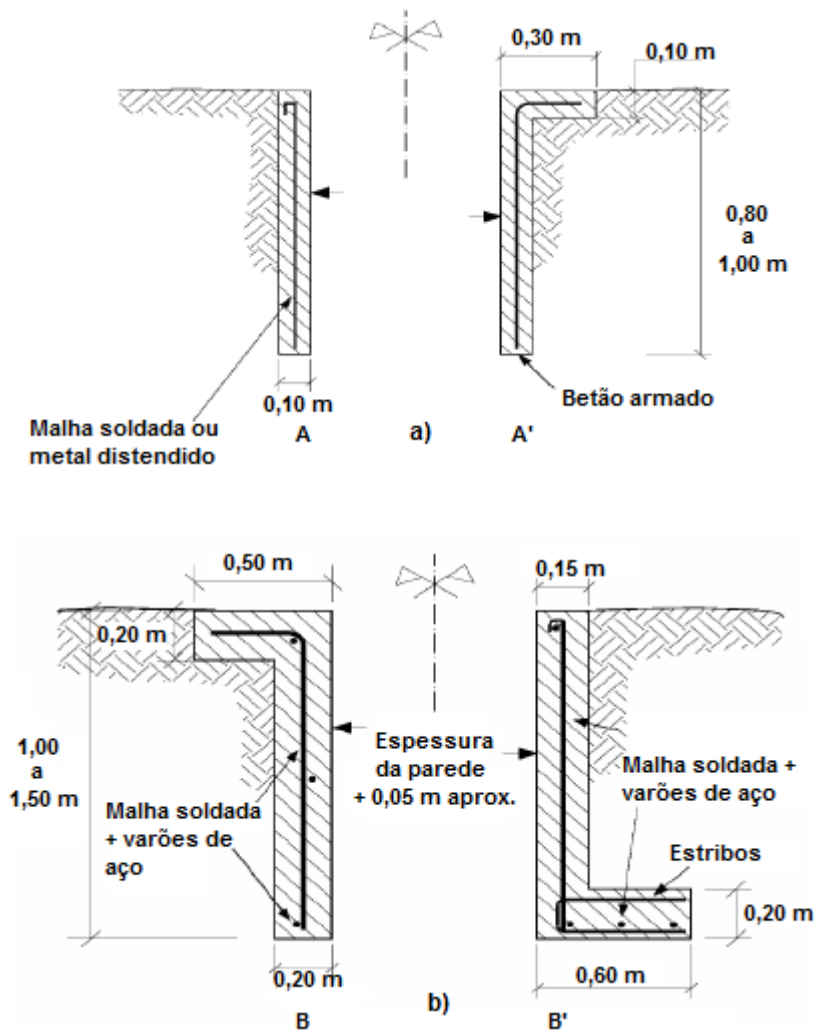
Esquemas de muros guia: a) tipo leve; b) tipo reforçado [22]
